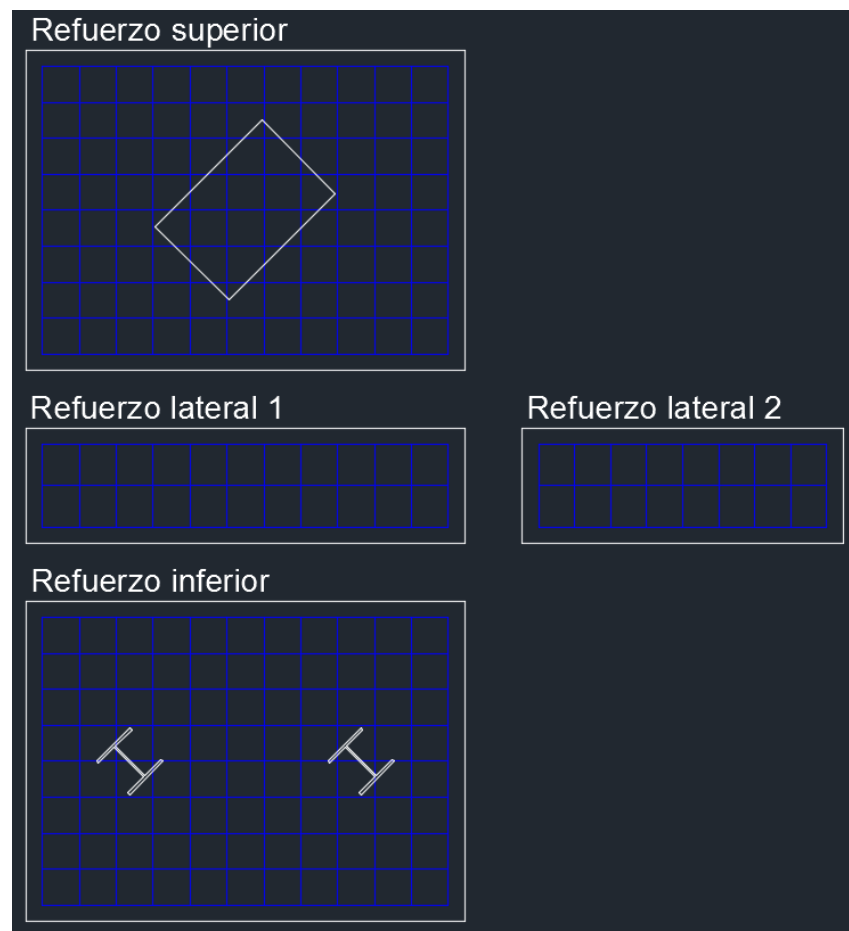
Refuerzo de los dados con dos pilotes. Fuente: Elaboración propia
